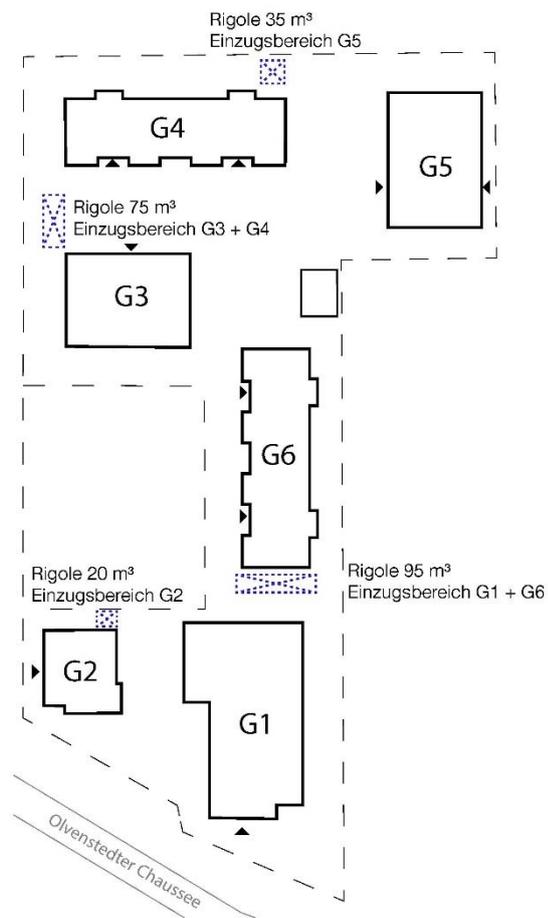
Rigolenstandorte mit Einzugsbereichen
